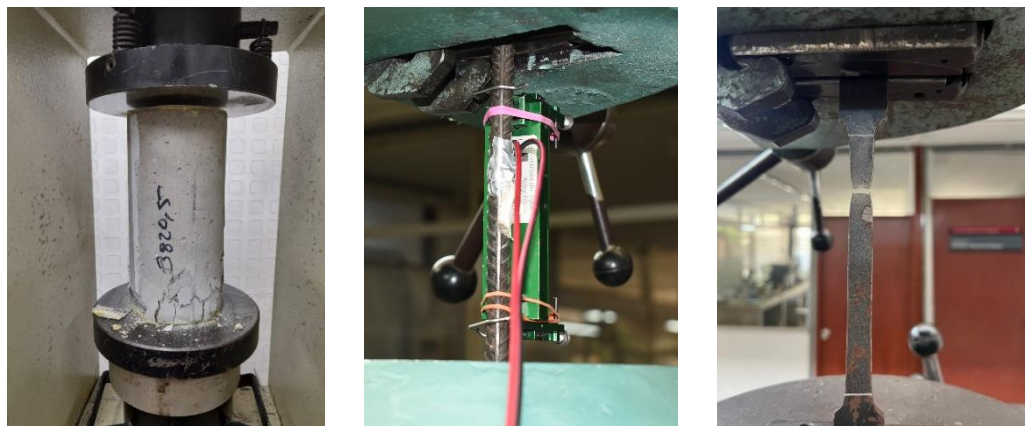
Ensayos del concreto, acero de refuerzo y platinas de confinamiento.
